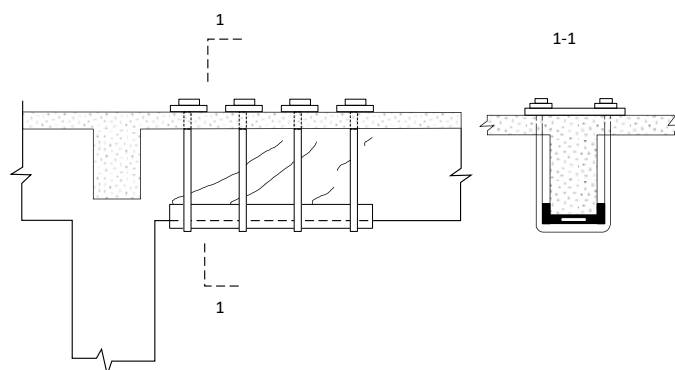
Saniranje dva AB elementa armaturnim šipkama
